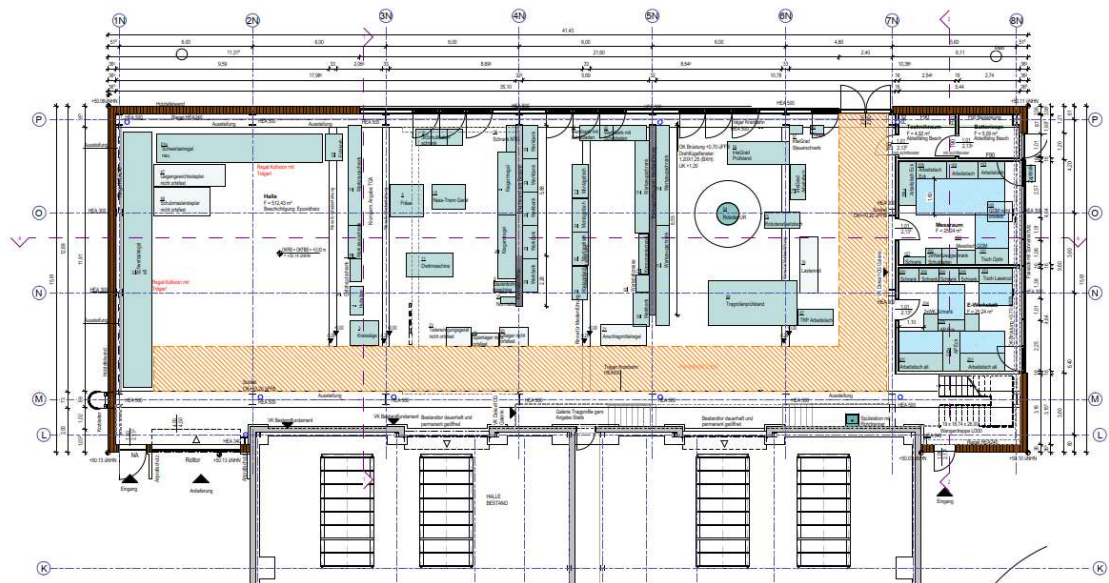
Grundriss Erdgeschoss, Quelle: Objektplaner
